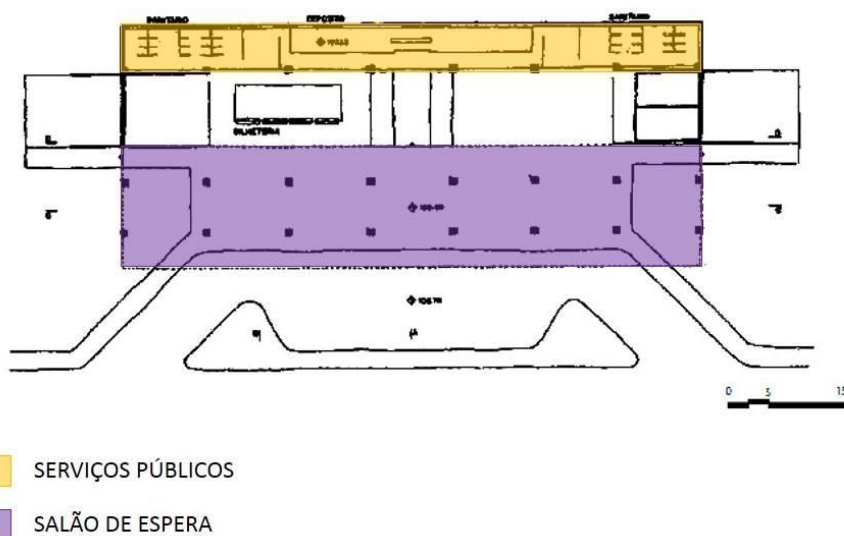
Planta pavimento térreo. Fonte: Adaptado www.arquiteturabrutalista.com.br
